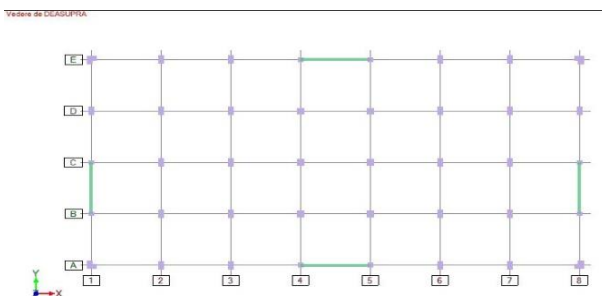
Vedere în plan structură cu 4 pereți pe laturi.
